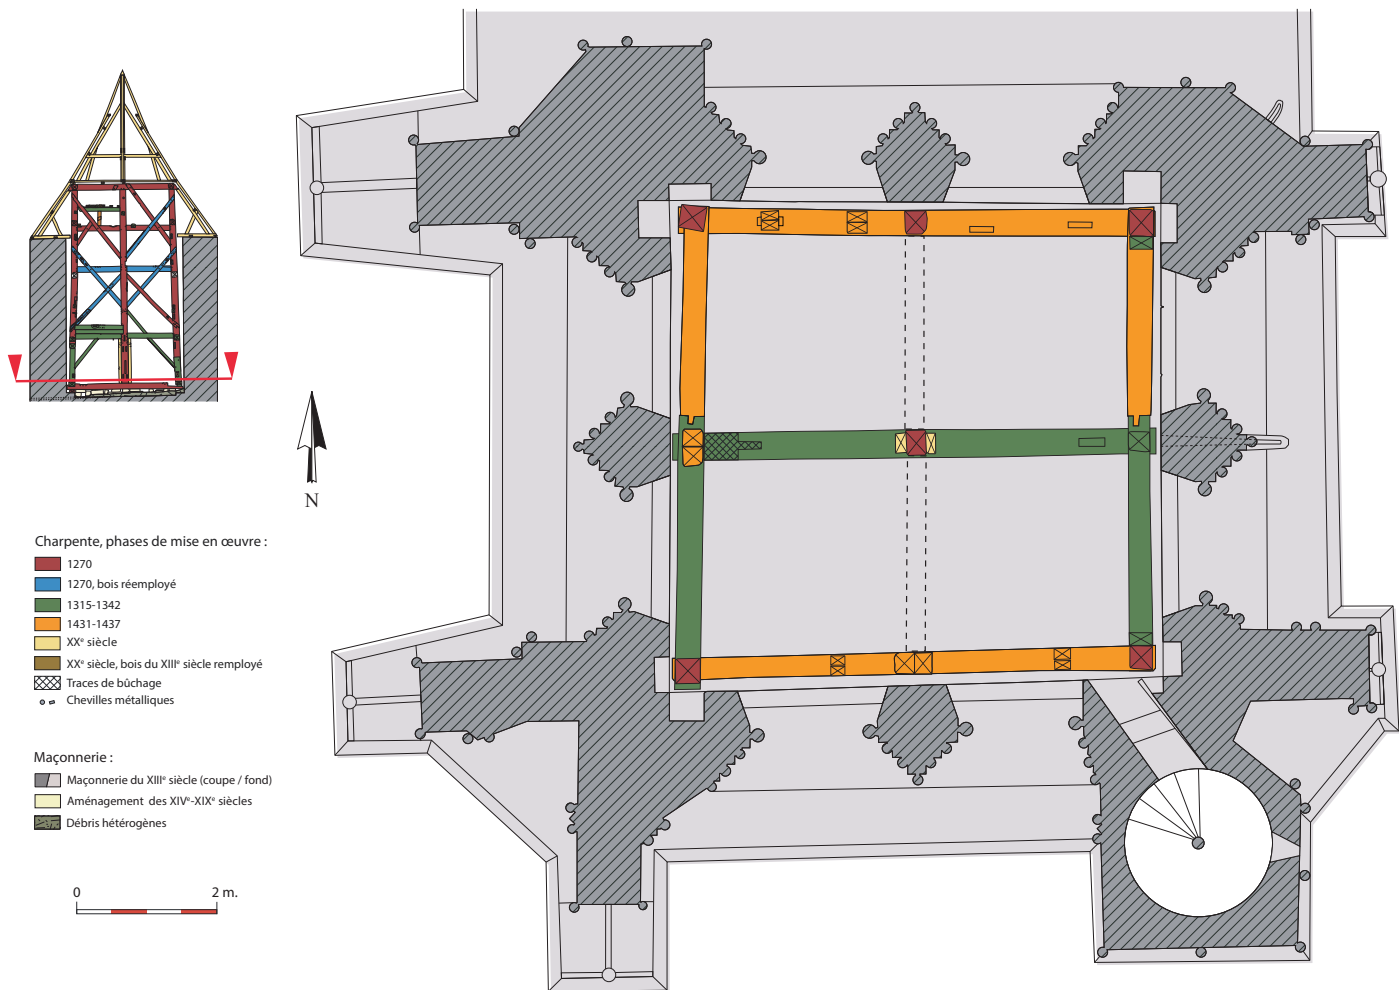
> Plan du beffroi au niveau des sablières basses.
